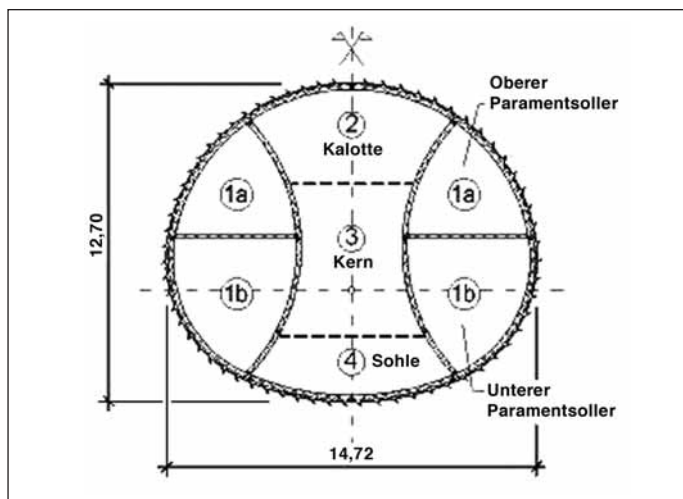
Jádrová (německá) soustava pilířového systému ražení
